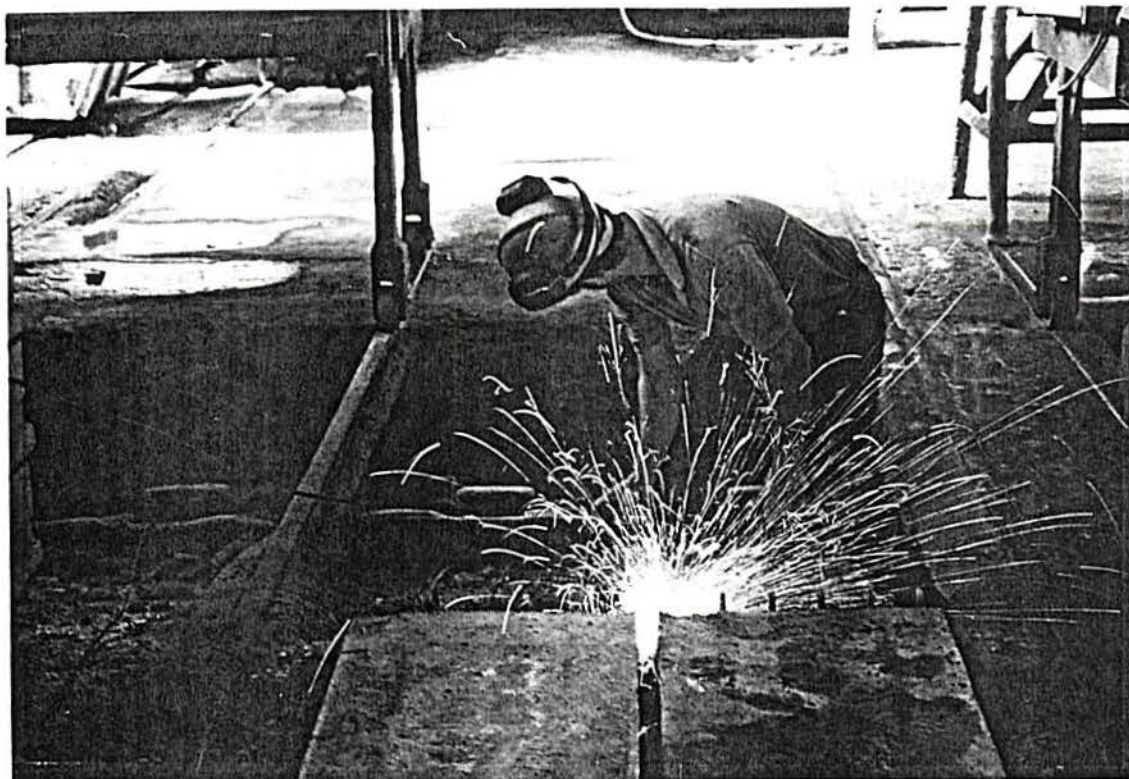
Vista do corte das cordoalhas na outra extremidade da pista
